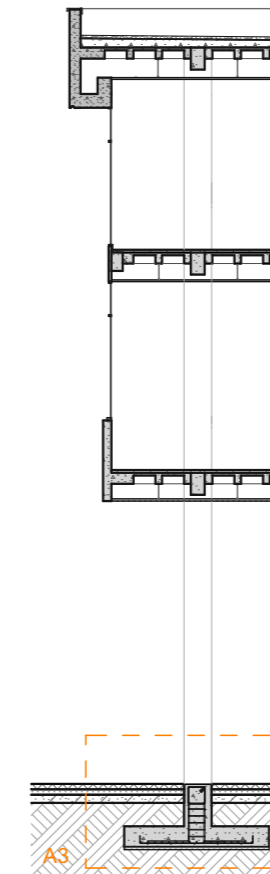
Detalle constructivo A2 | Fuente: Elaboración propia
